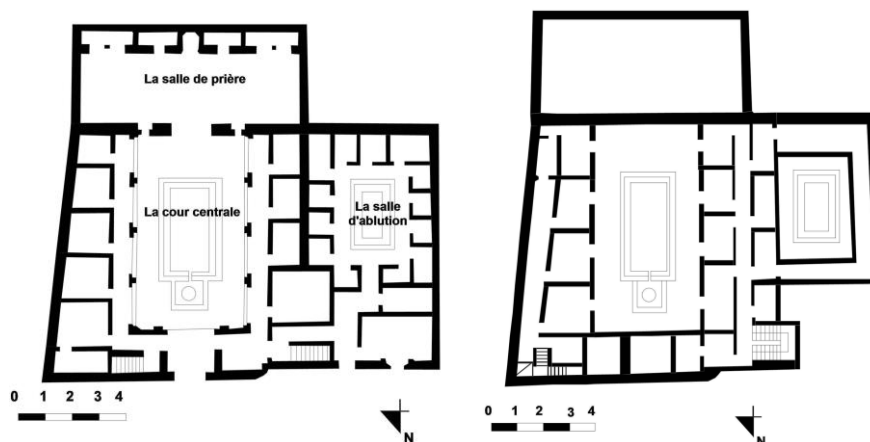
Vues en plan de la medersa el-Sahrîj : rez-de-chaussée à gauche et premier étage à droite
